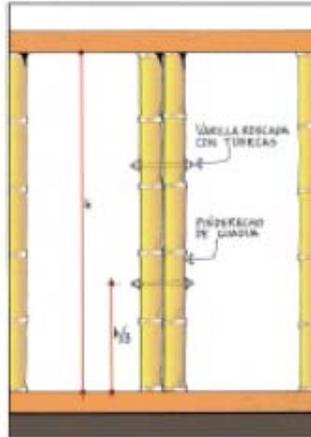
Unión entre paneles en el mismo plano. Fuente AIS
